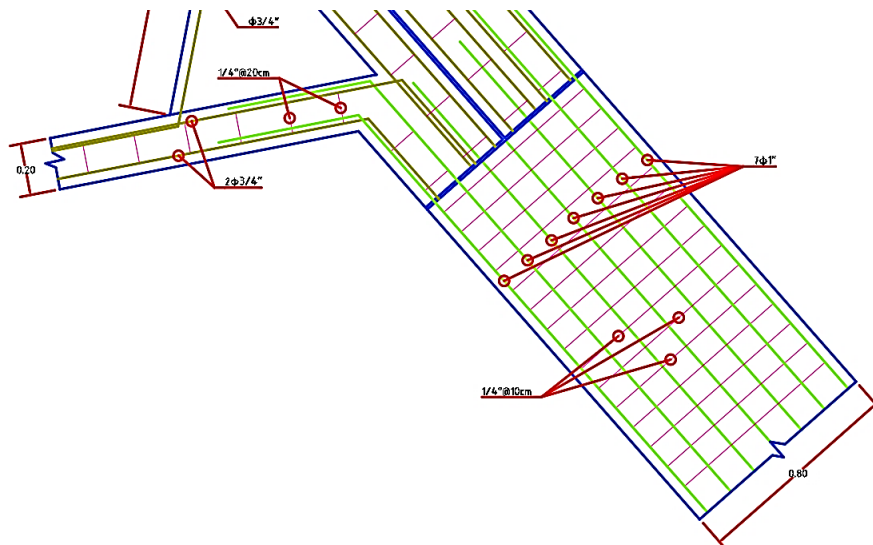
Detalle 2 - Unión de columnas inclinadas
